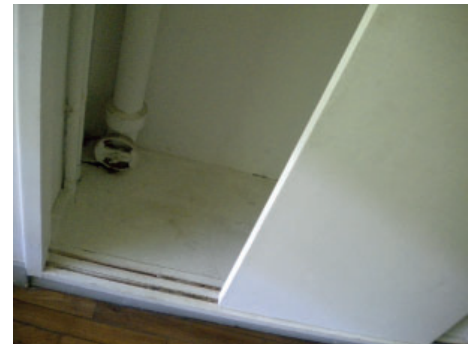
Bajante dentro del armario de un dormitorio de planta baja en la *Villa Savoye*. Fotografía del autor.
